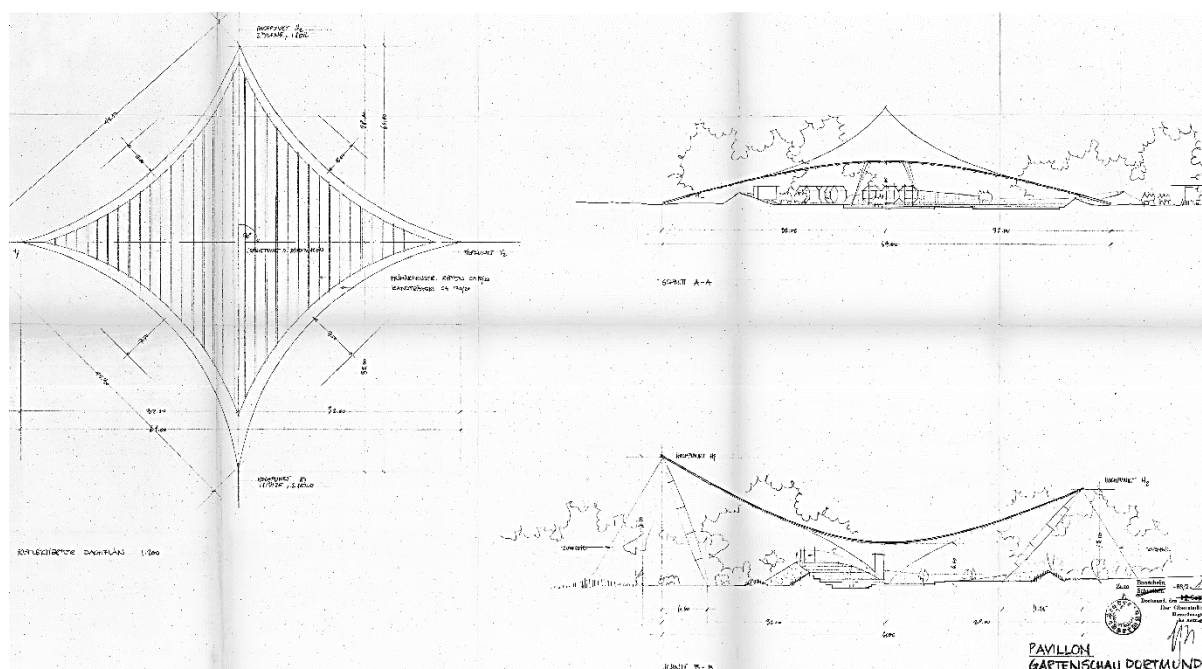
Dachplan und Schnitte, Ingenieurbüro Dr.-Ing. G. Scholz, München (Plan vom 07.08.1968)
